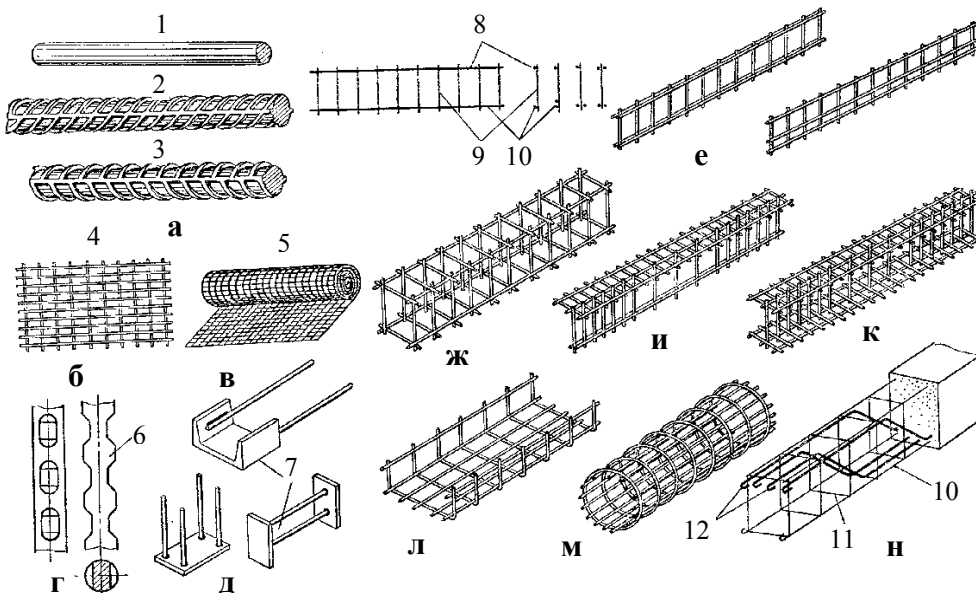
Види арматури: а – арматурні стрижні; б – плоска арматурна сітка; в – рулонна арматурна сітка; г – дротяна арматура періодичної дії; д – закладні деталі; е – плоскі каркаси; ж – просторовий каркас; и – просторовий каркас таврового перерізу; к – просторовий каркас двотаврового перерізу; л – гнутий каркас; м – циліндричний каркас; н – каркас з відігнутими стрижнями в'язаний; 1 – стрижень круглий гарячекатаний; 2, 3 – стрижень періодичного профілю; 4 – сітка зі стрижнів періодичного профілю; 5 – сітка з круглих стрижнів; 6 – профіль холодносплющеної арматури; 7 – способи кріплення закладних деталей до арматури; 8 – верхні монтажні стрижні; 9 – поперечні монтажні та робочі стрижні; 10 – нижні робочі стрижні; 11 – хомути; 12 – кінцеві гаки
